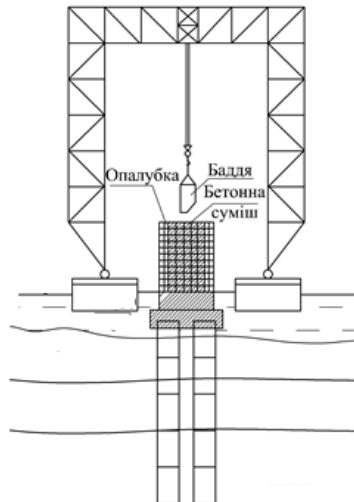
Встановлення опалубки та бетонування тіла опори
